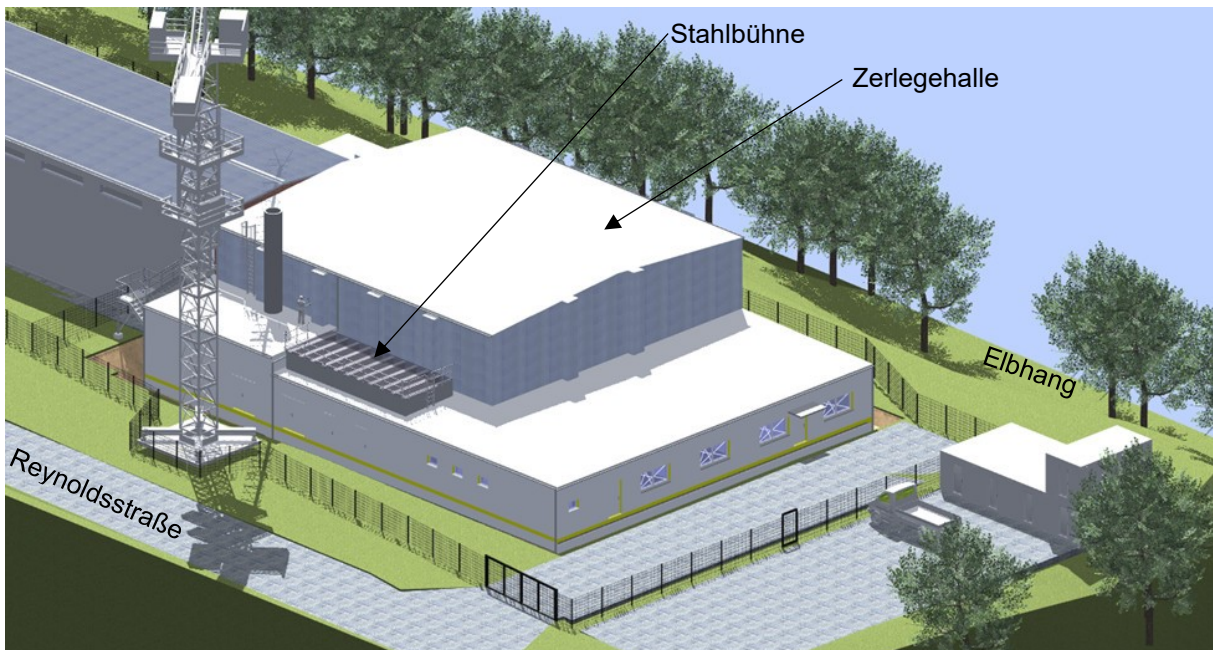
Dachabdichtung, Fassadenverkleidung und Montage der Außentreppe, Stahlbühne etc., Ansicht von Nord-Westen
